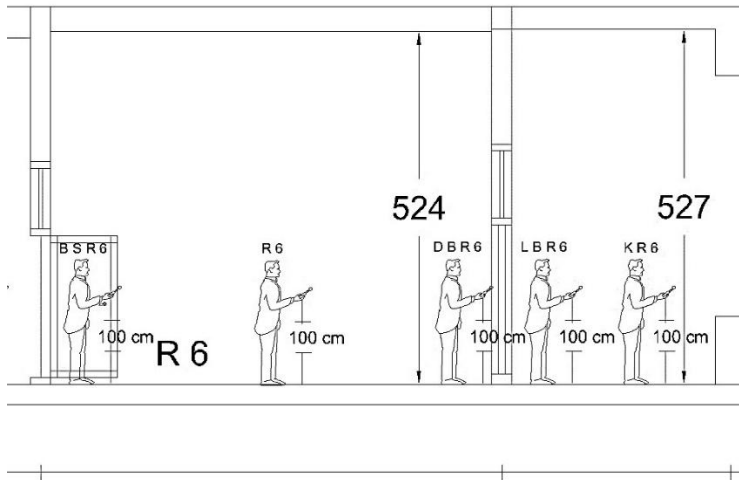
Ruang Sampel Pengukuran Gedung A Lantai 1 Lawang Sewu
